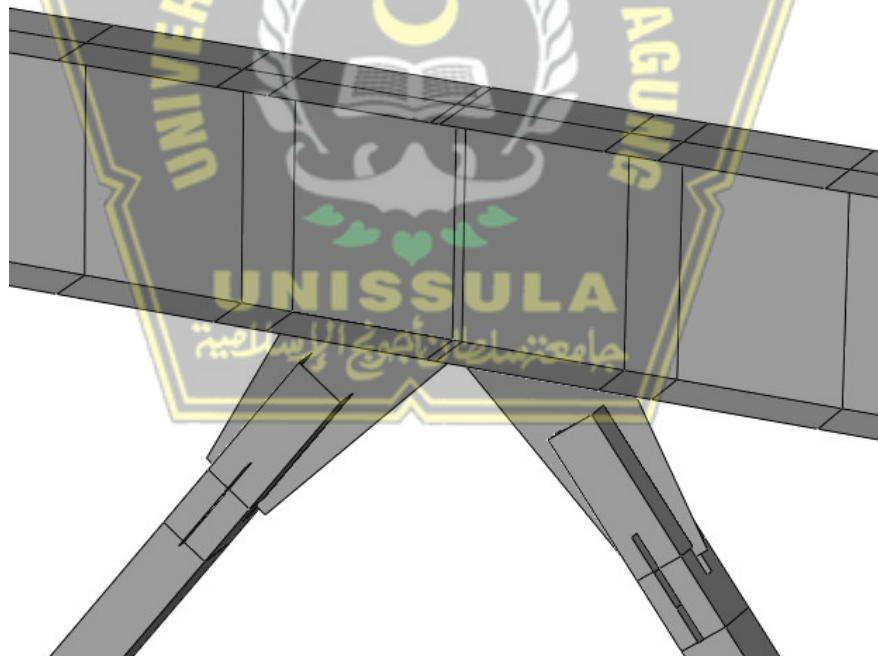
Detail Sambungan Bresing-Balok spesimen 1
